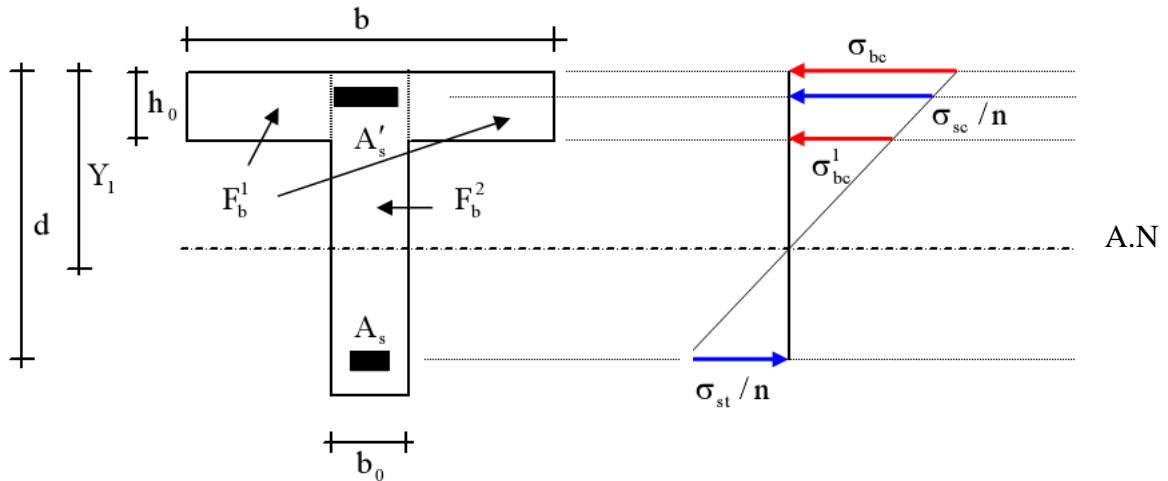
notation utilisées pour le calcul du ferrailage pour une section en T
